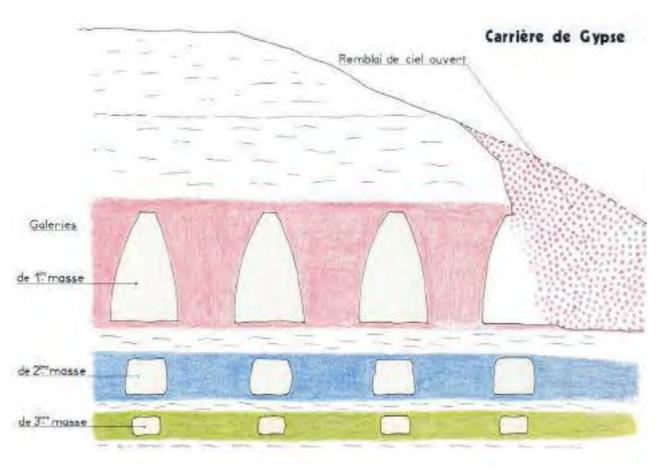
Schéma d'une exploitation par piliers abandonnés dans le gypse
